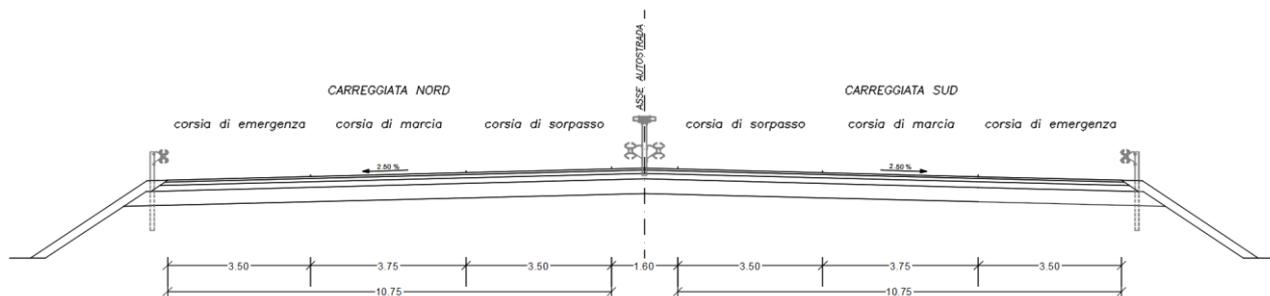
Sezione tipo in rilevato (rettifilo)
